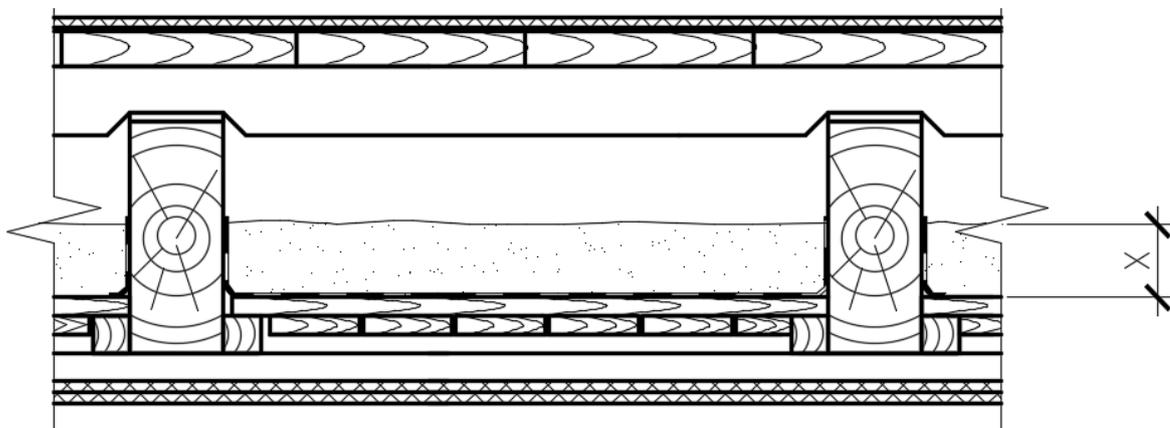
Схема междуэтажного перекрытия на деревянных балках
